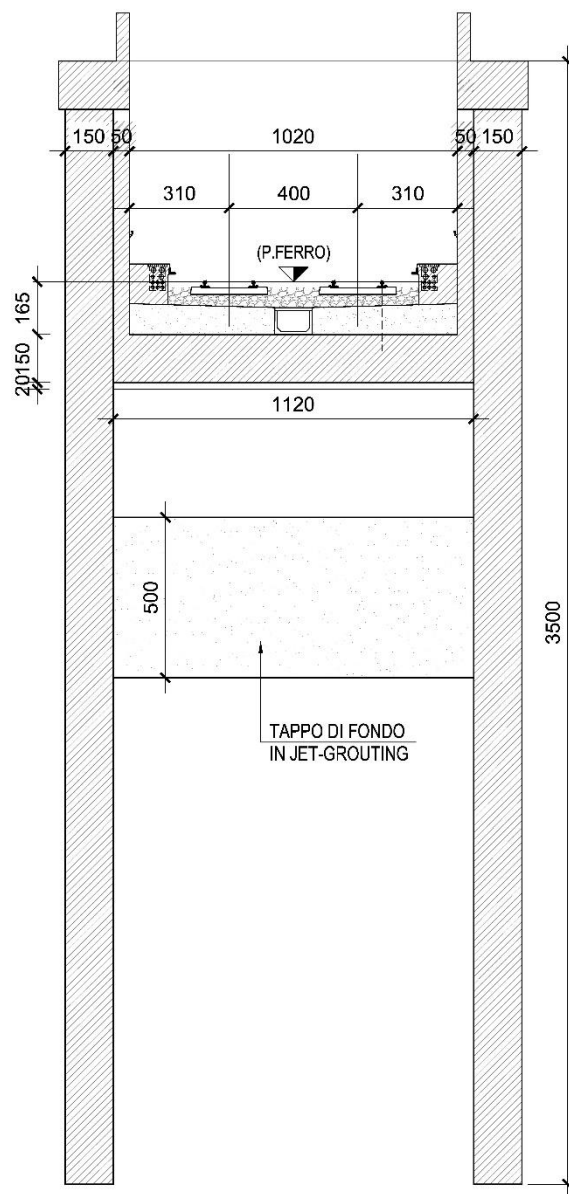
Schema semplificato delle opere in progetto in corrispondenza della Sezione 1.
